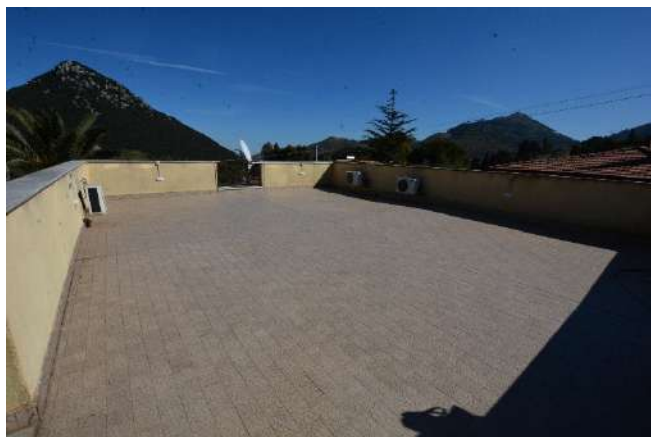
(Allegato 9) Lastrico solare di 1° piano – Fig. 5, p.lla 517, sub.3
